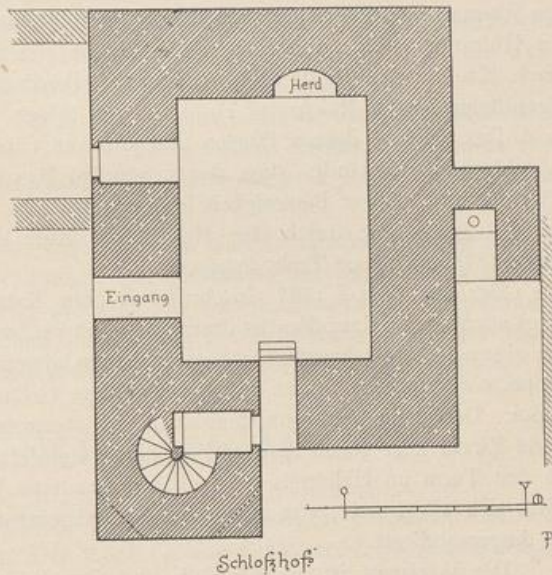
Landsberg. Grundriss des Bergfriedes.
